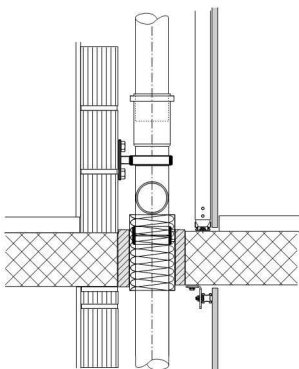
Schnitt A - A, Befestigungsdetail des Installationssystems Geberit Duofix oder Geberit GIS neben Deckendurchbruch
